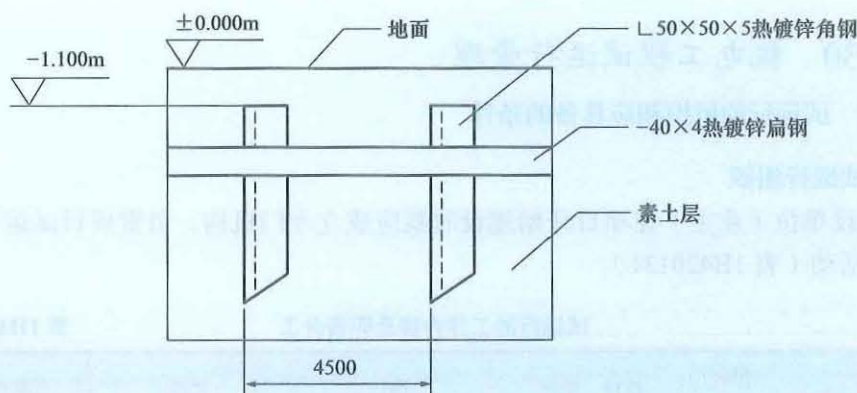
H420125-4 接地装置断面图 (尺寸单位: mm)
